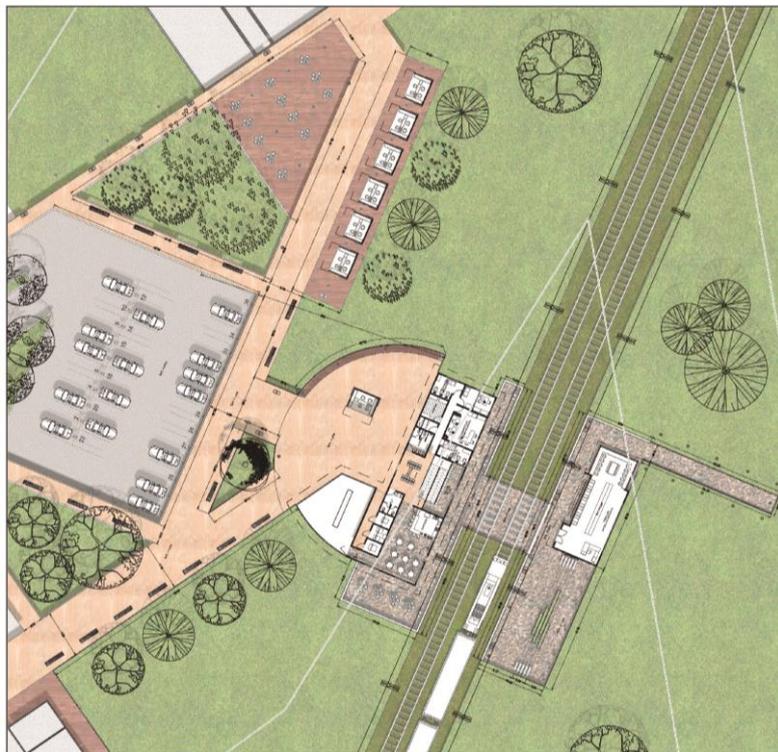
Planta espacio público estación Paz de Río. Autoría propia. (2019)
